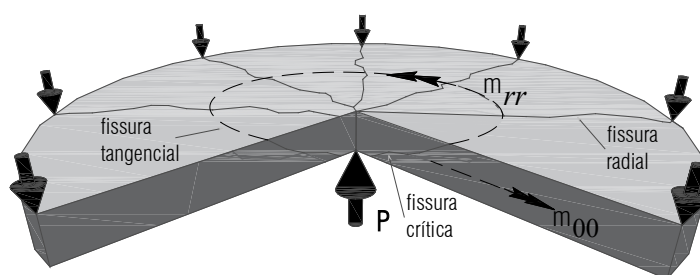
Fissuras radiais e tangenciais em lajes lisas
